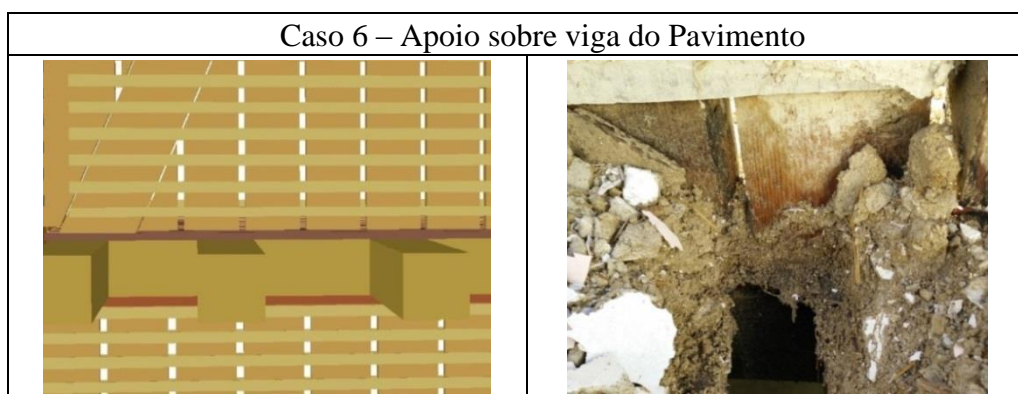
Ligações inferiores de tabique a vigas ou outros elementos - Caso 6
